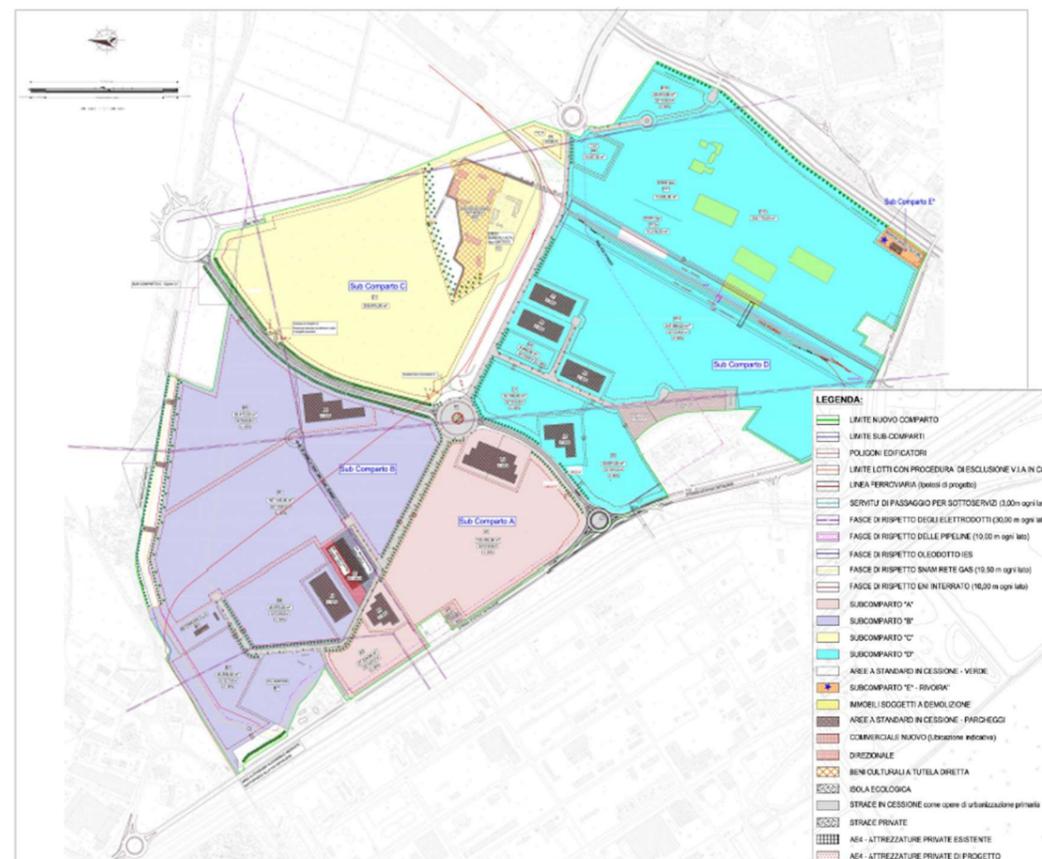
Planimetria di progetto piattaforma intermodale ferro/gomma. Fonte: Provincia di Mantova.
